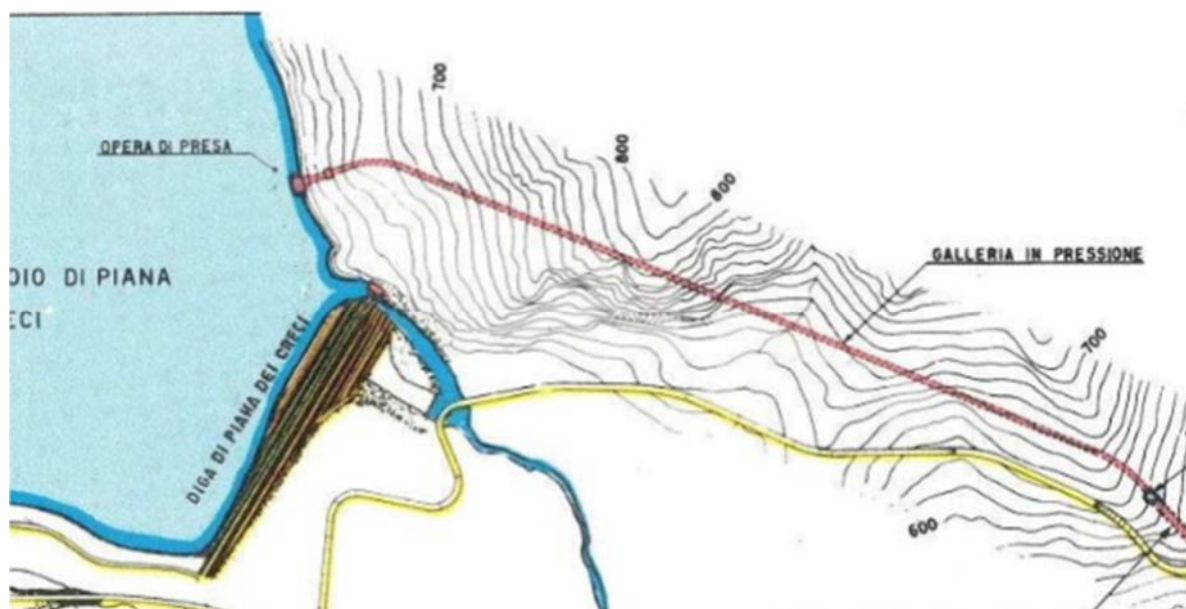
Galleria di derivazione – Planimetria (ENEL, 2013)
